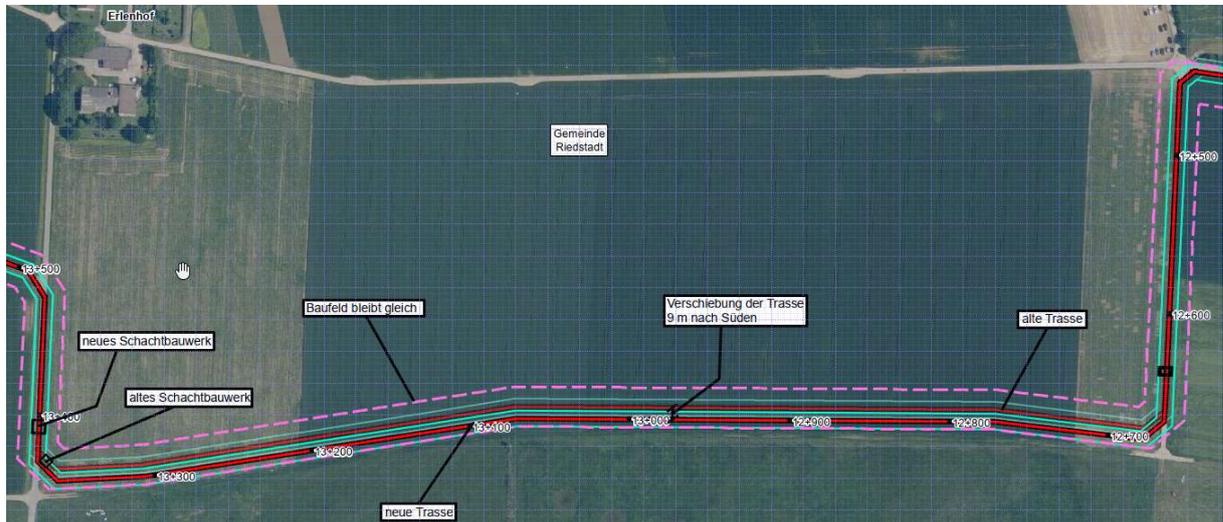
Detaillageplan Trassenoptimierung (Legende: siehe Anhang 3)
